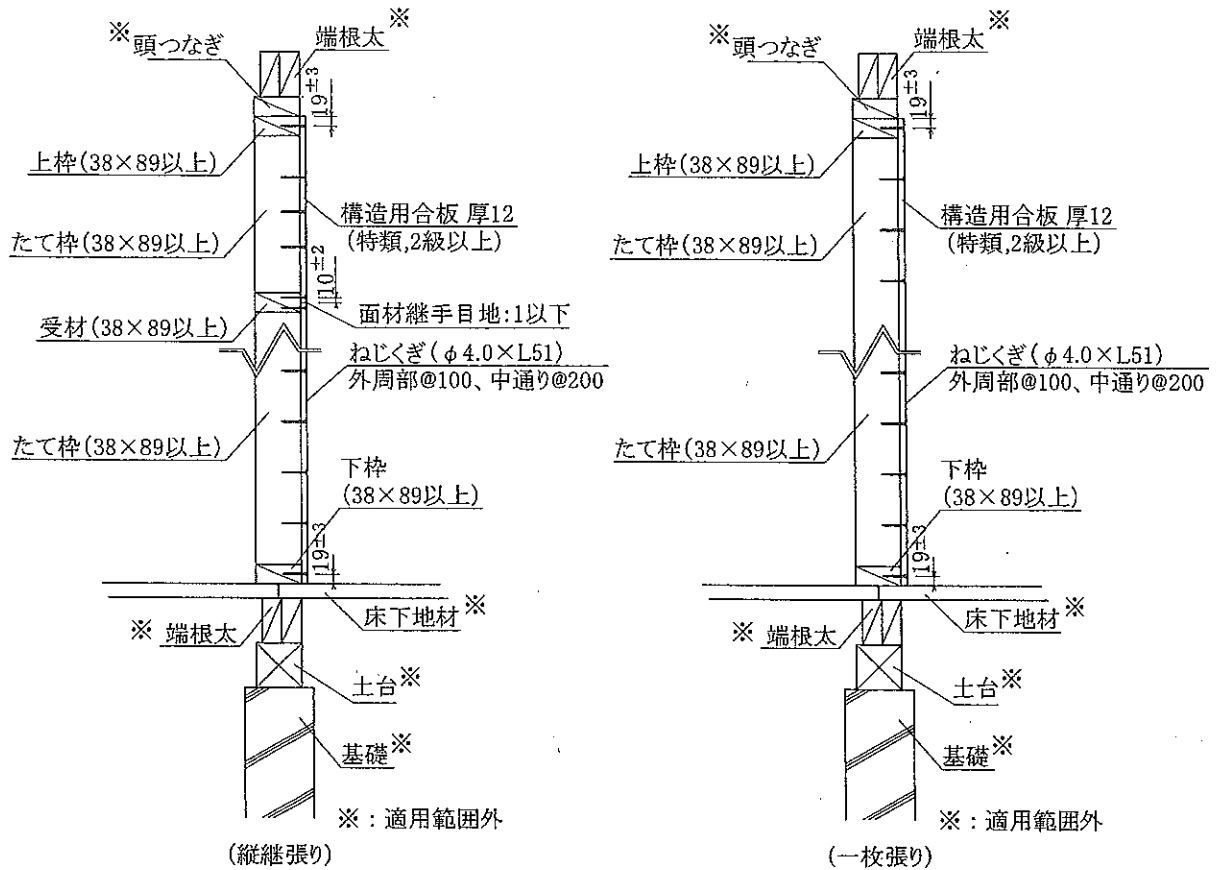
施工図 (鉛直断面図) (寸法単位: mm)
